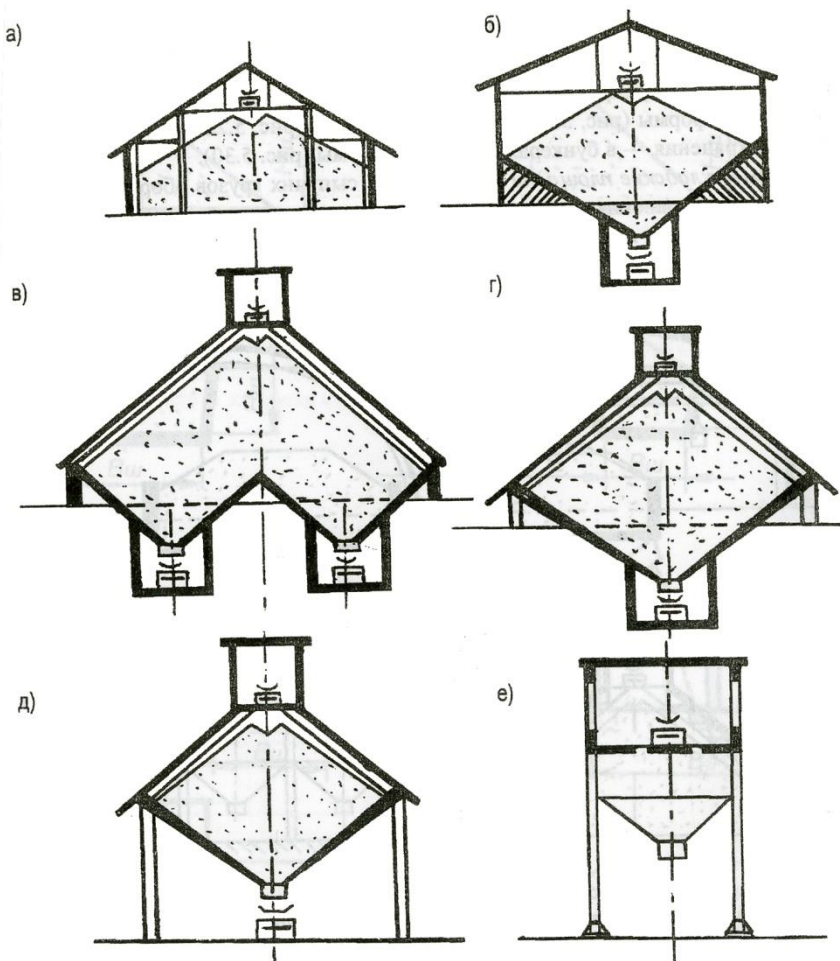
Устройства для закрытого хранения сыпучих грузов:
